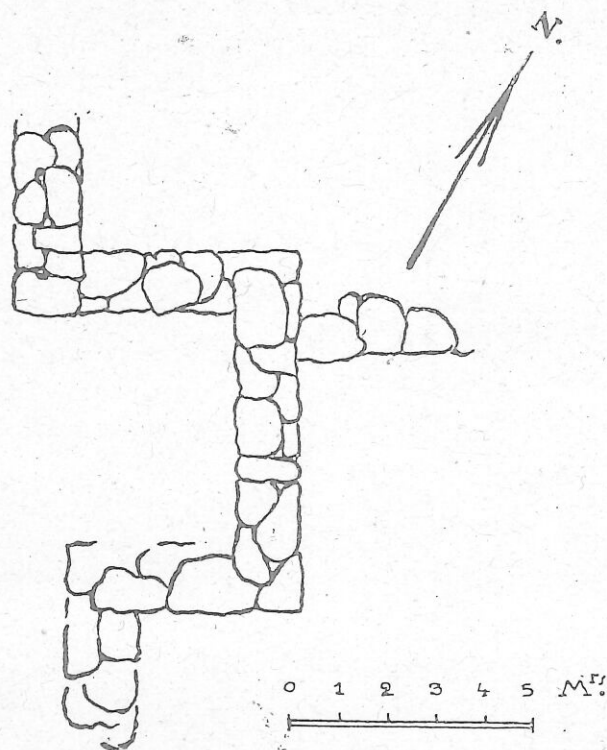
Planta d'una de les torres de la muralla de Burriac (per M. Ribes)
